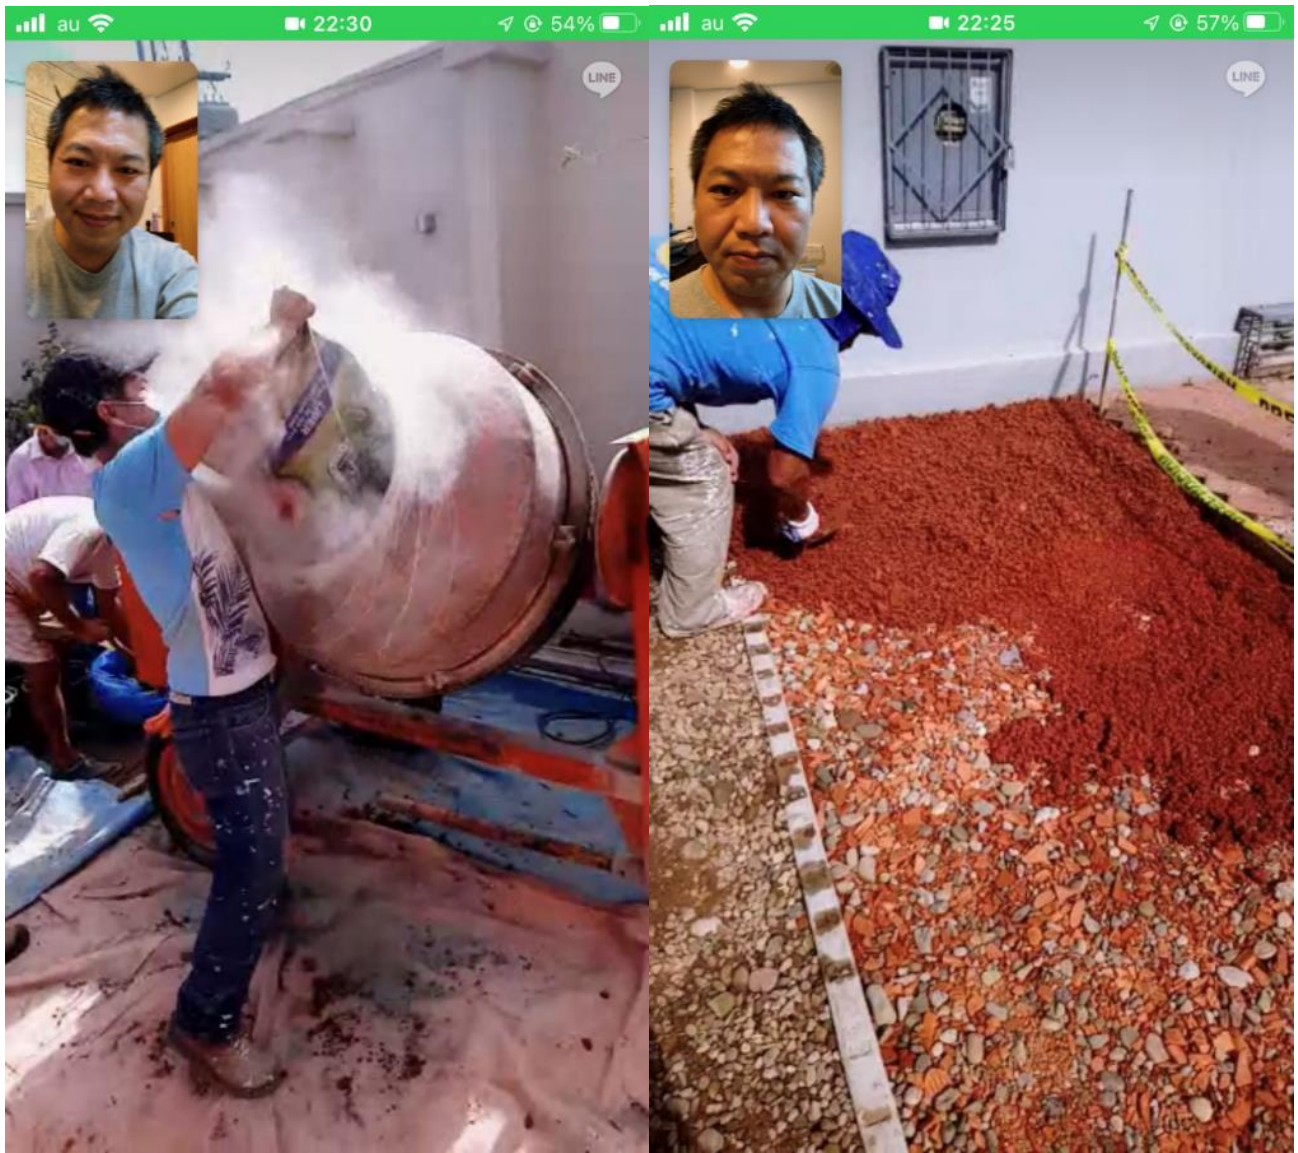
試験施工状況 2 (表層舗装材製造、打設敷均し状況)
